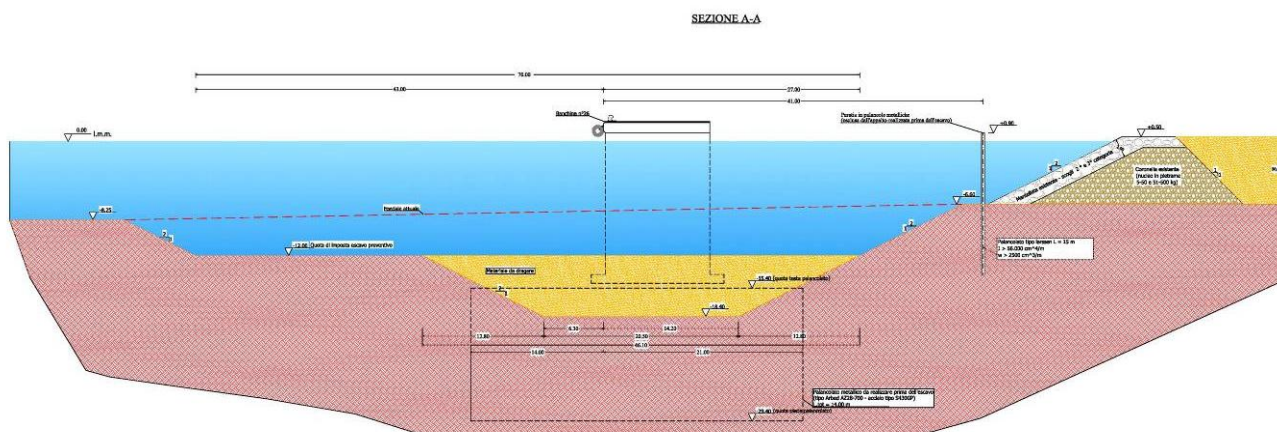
Sezione di escavo prevista in progetto esecutivo banchina 27
